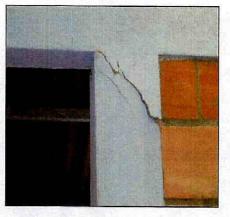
Grieta en la columna de la habitación principal en la Cra. 71J # 68A-21 Sur
